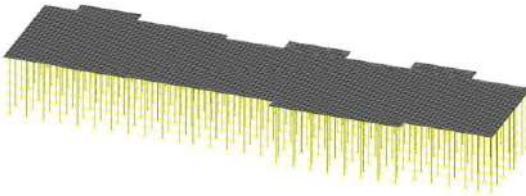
Расчетная модель свайно-плитного фундамента
